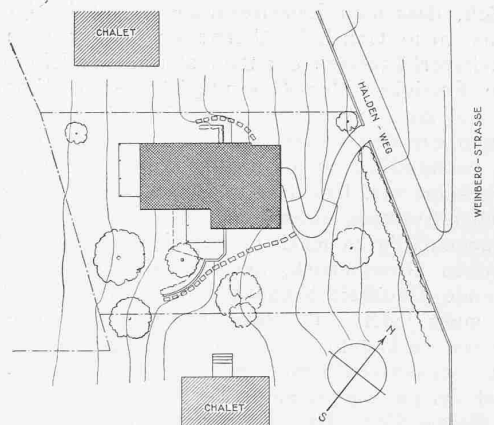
Wohnhaus am Haldenweg in Kilchberg. Lageplan 1 : 800, mit Meter-Kurven.
